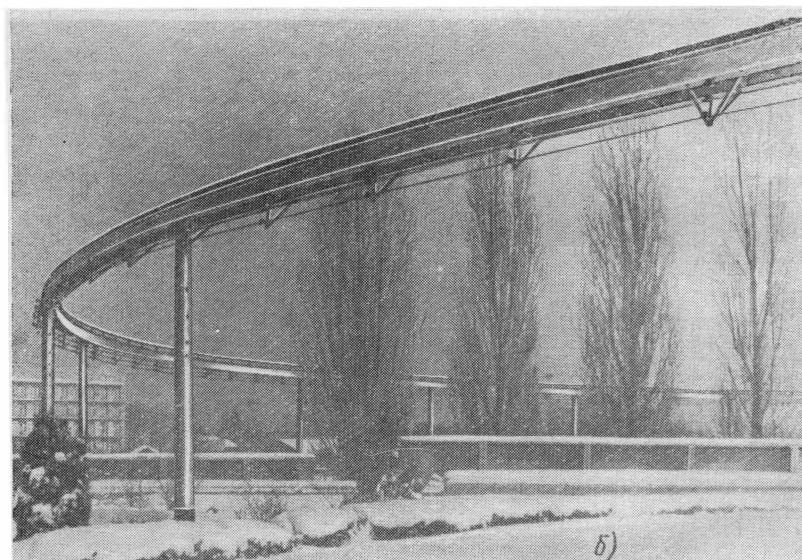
Опытный участок навесной монорельсовой дороги с линейным двигателем:
